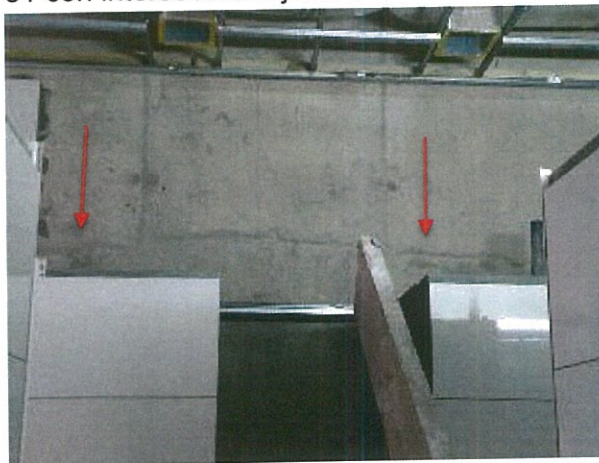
, 03-07-2015, juntas de construcción mal ejecutadas en muros del eje H1, entre los ejes 6a y 7a.
